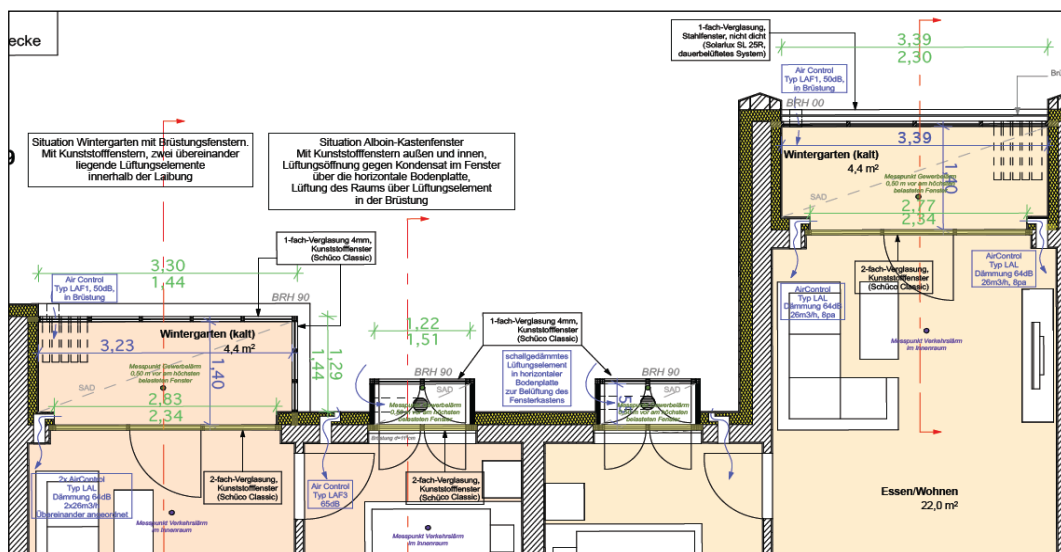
Grundrissdarstellung Häuser 9 und 6, Nordfassaden mit Wintergärten und Kastenfenstern, Stand September 2015
